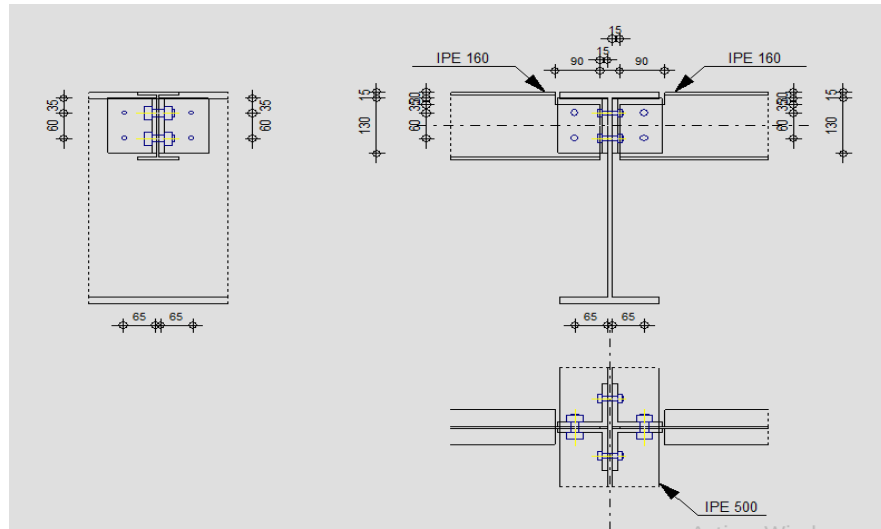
Detaille d'Assemblage solive-poutre principale
